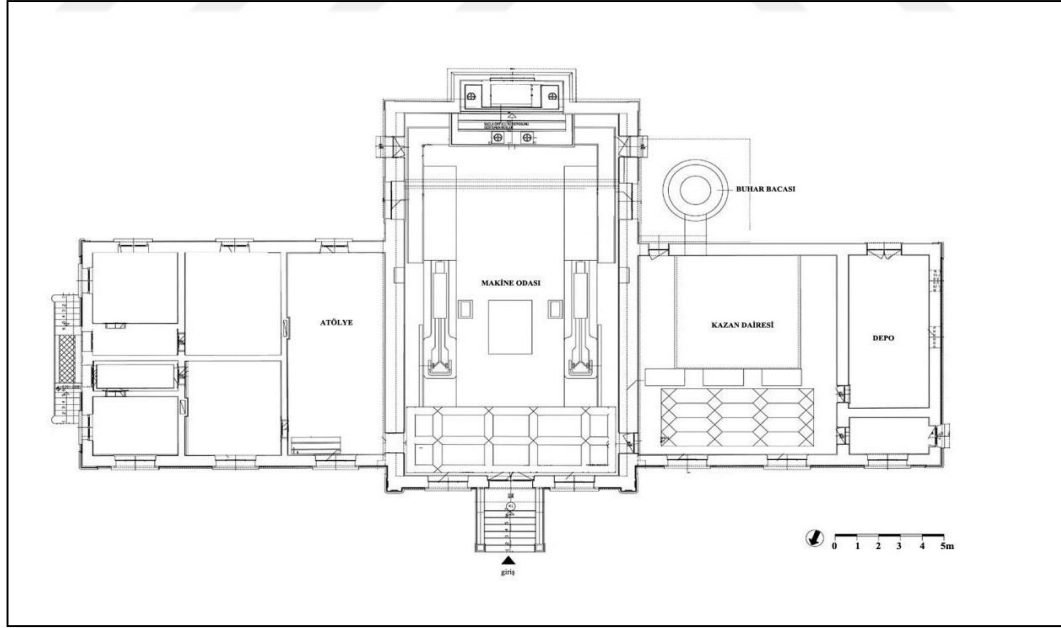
Mecidiyeköy Likör Fabrikası vaziyet planı ve kat planı rölövesi (Kambek, 2005).
